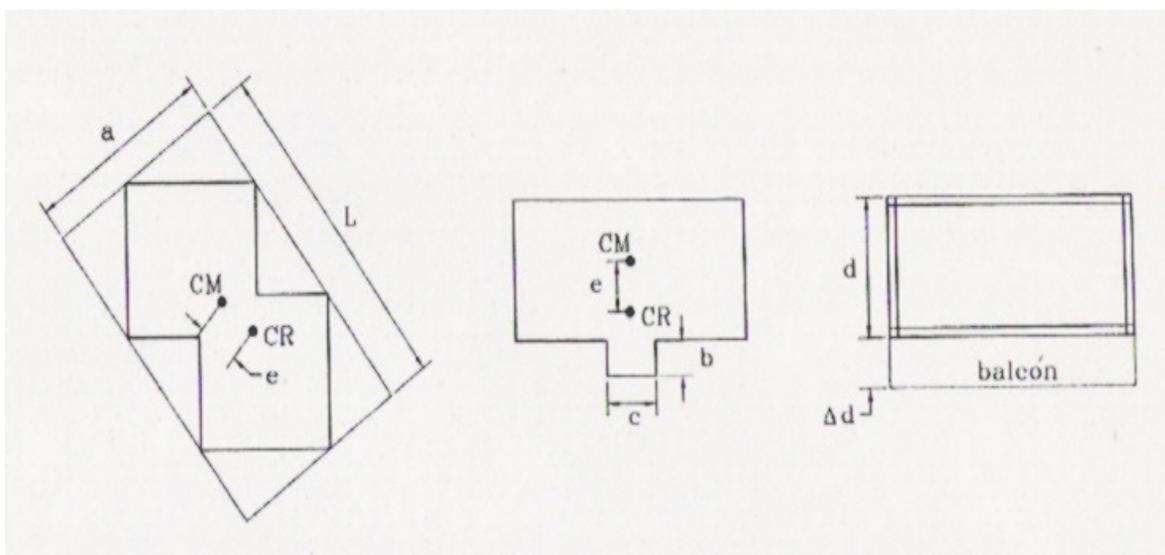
Parámetros que se utilizan en la evaluación de la configuración en planta de un edificio.
